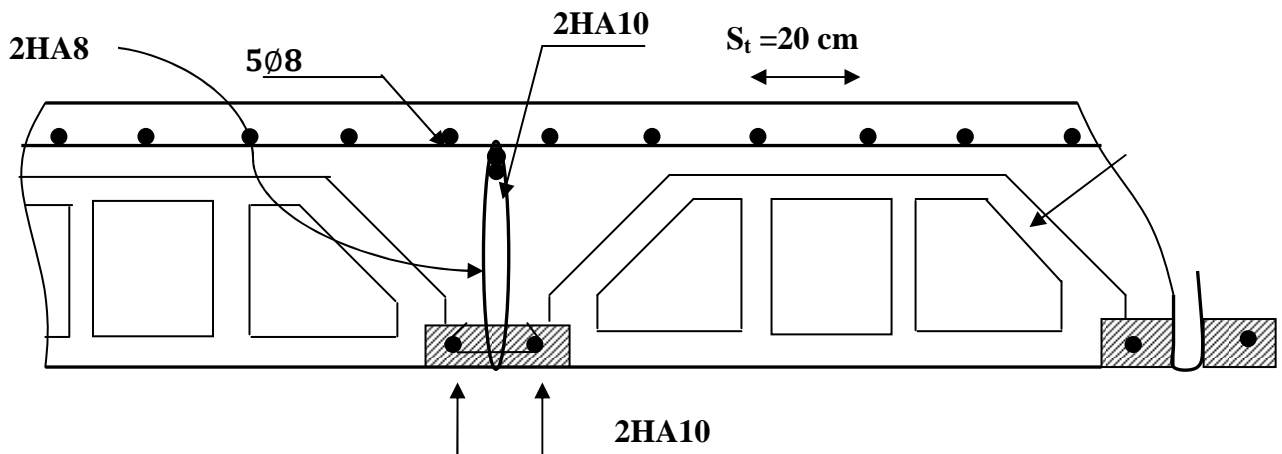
Ferrailage de la dalle de en corps creux.
